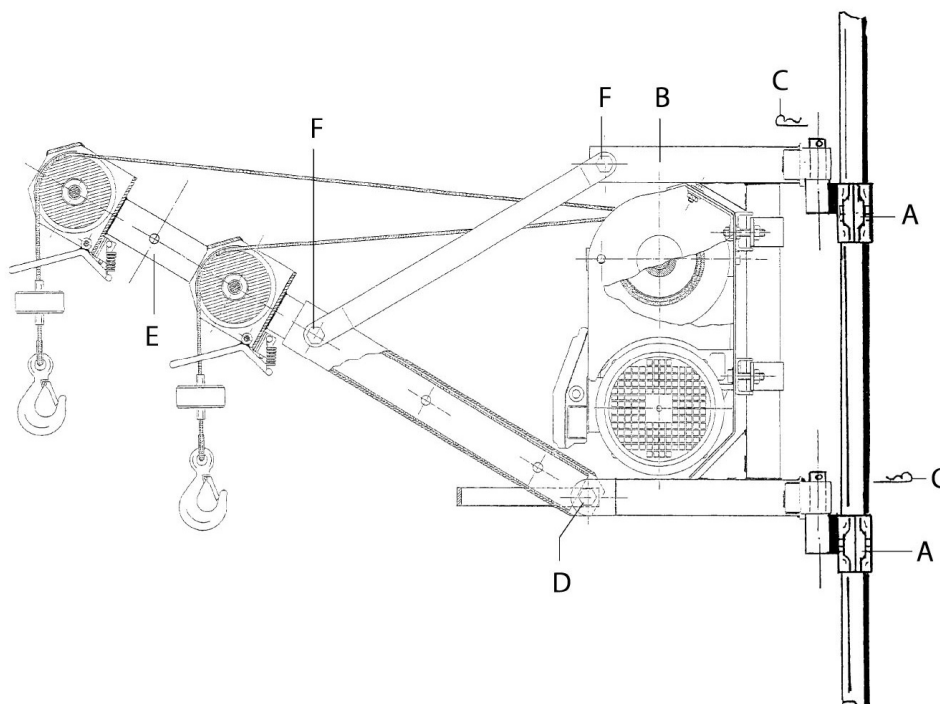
Instalação do elevador sobre prumo ou estrutura portante
